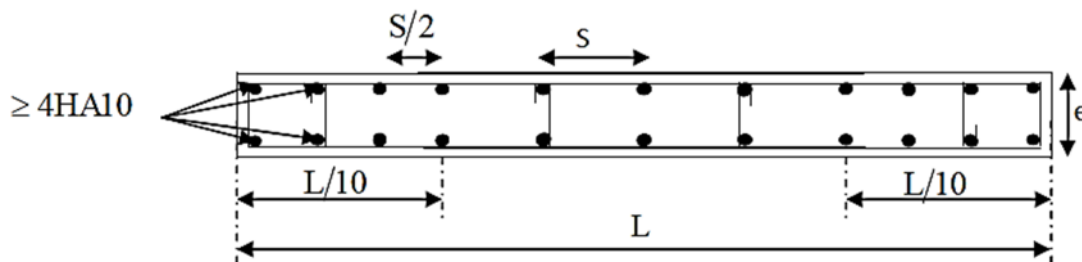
Disposition des armatures verticales dans les voiles
